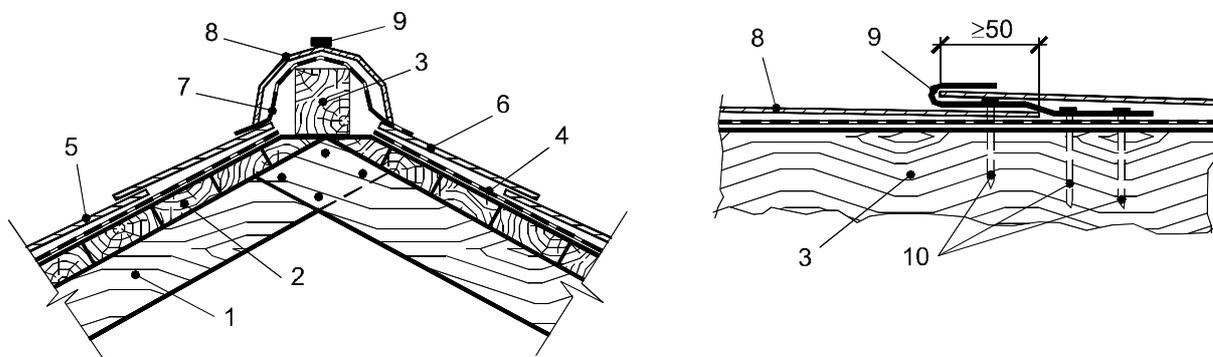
Вариант горизонтальной двухслойной раскладки плоских кровельных асбестоцементных плиток:
